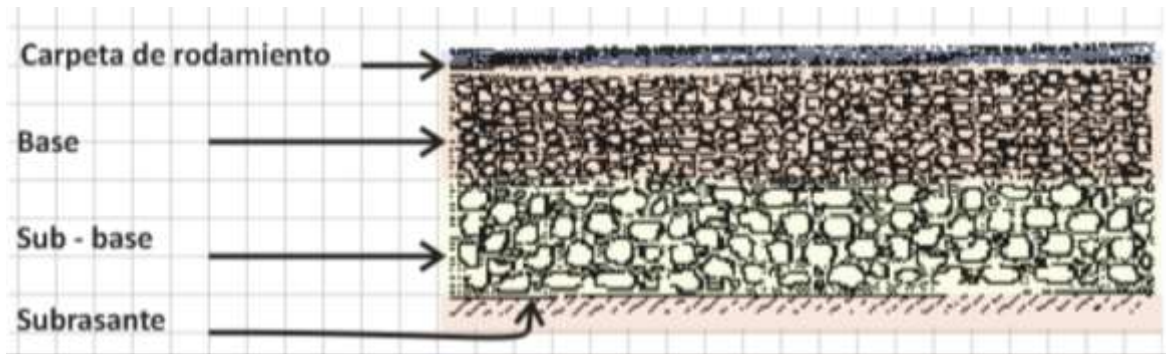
Sección de pavimento flexible. (Fuente: Manual para la revisión de diseño de pavimentos)
